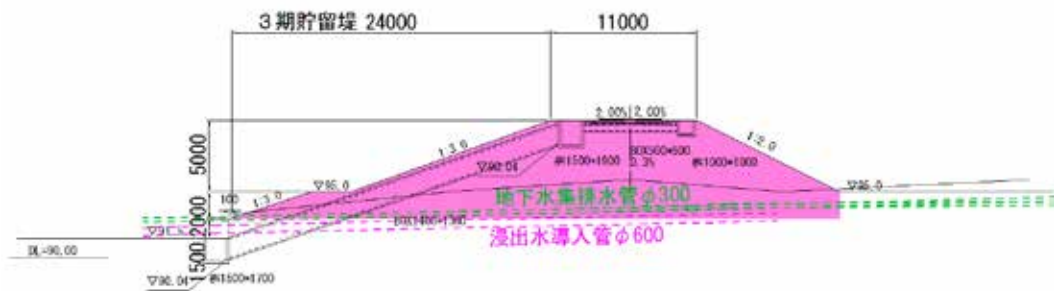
第 2 貯留堤 (第 3 期工事) 平面图
